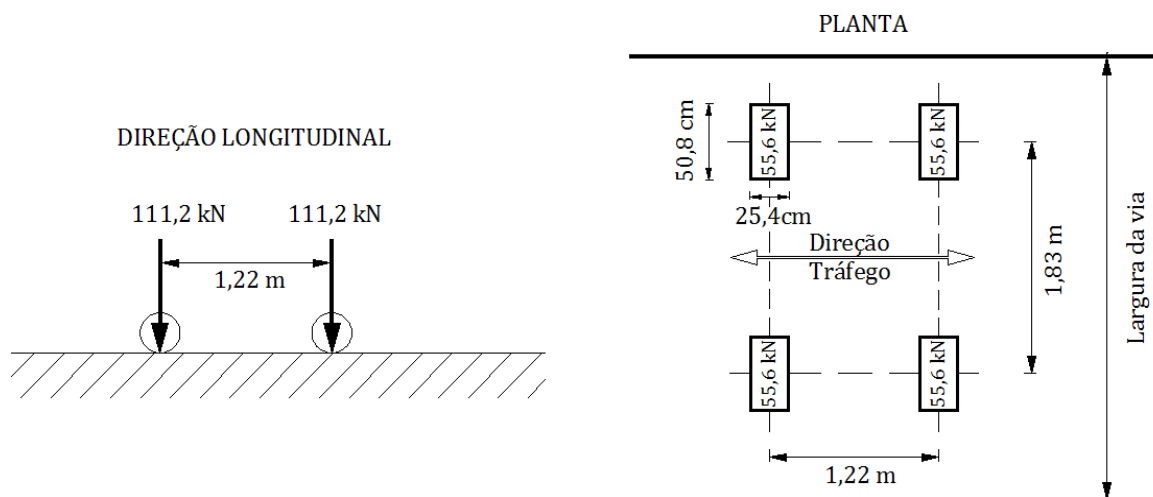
Tandem* (H20-44) em planta e na direção longitudinal
